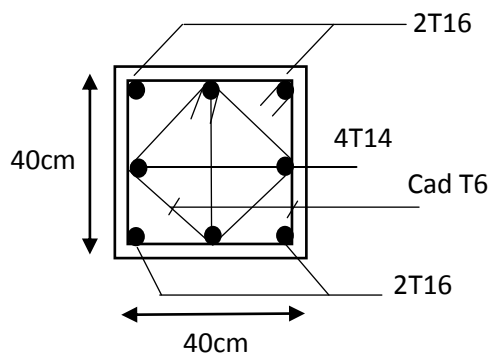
ferrailage de poteaux (40×40) cm²
